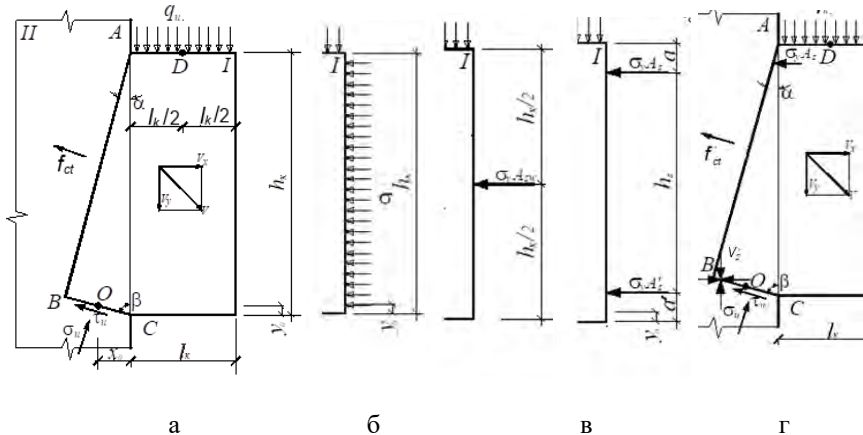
Кінематично можлива схема руйнування прямокутних шпонок при зрізі: а – бетонних; б – обтиснутих; в – залізобетонних при розташуванні арматури в один і два рівні без врахування нагельного ефекту; г – залізобетонних при двоюрисному розташуванні арматури і врахуванні нагельного ефекту в стиснутій арматурі
